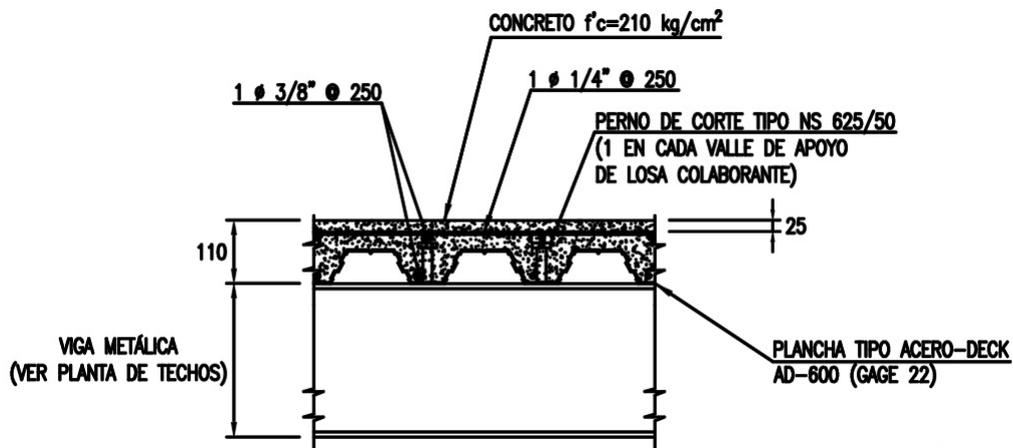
Perfil típico de losa colaborante. Fuente: Planos del proyecto
